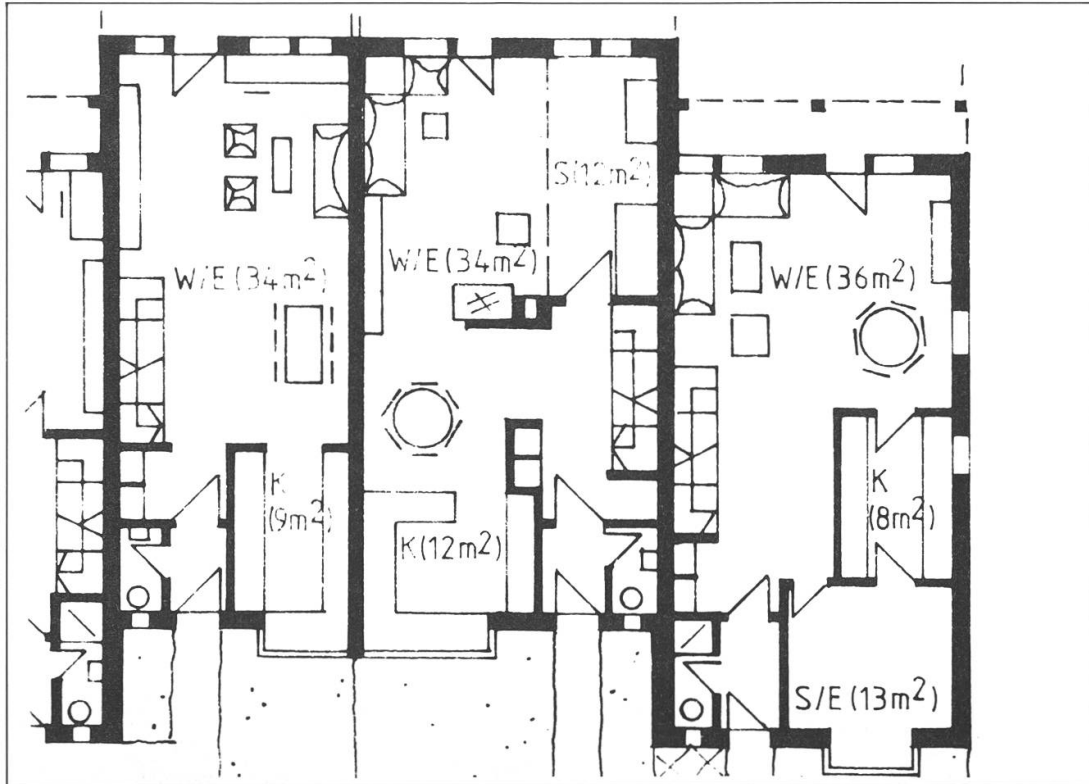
Grundrisse zu Reihenhaustypen laut Vorprojekt (mit, von links, 120, 153 und 144 m²; Obergeschosse siehe Abb. 17)
